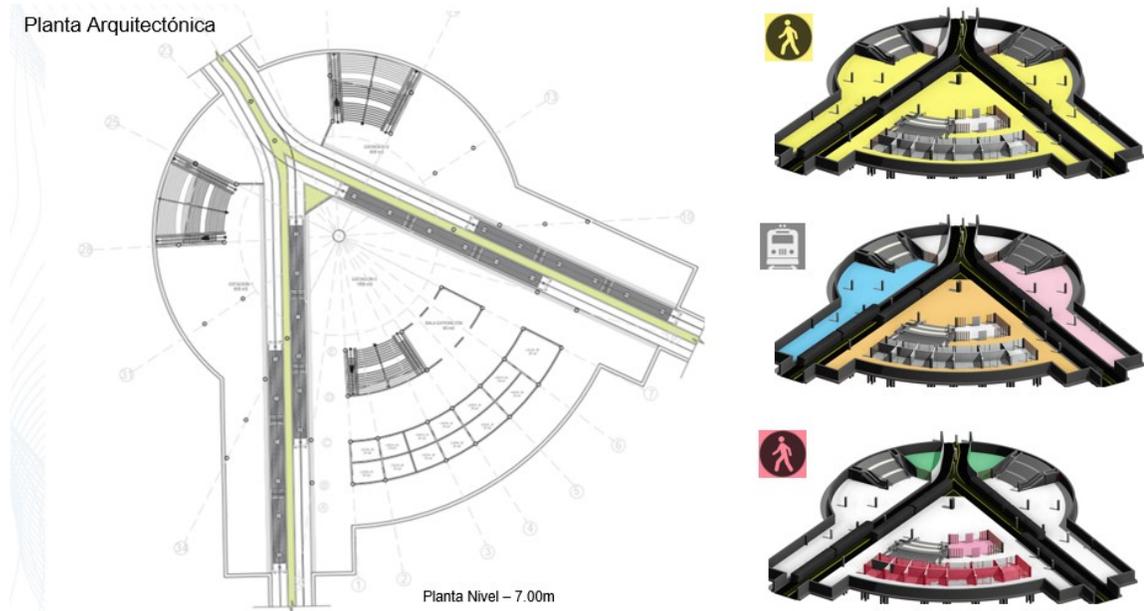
Planta Arquitectónica Nivel -7.00m
